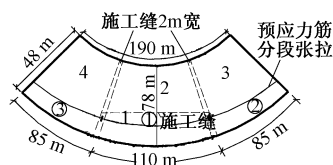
混凝土分段施工、预应力筋分段张拉示意(东区)
